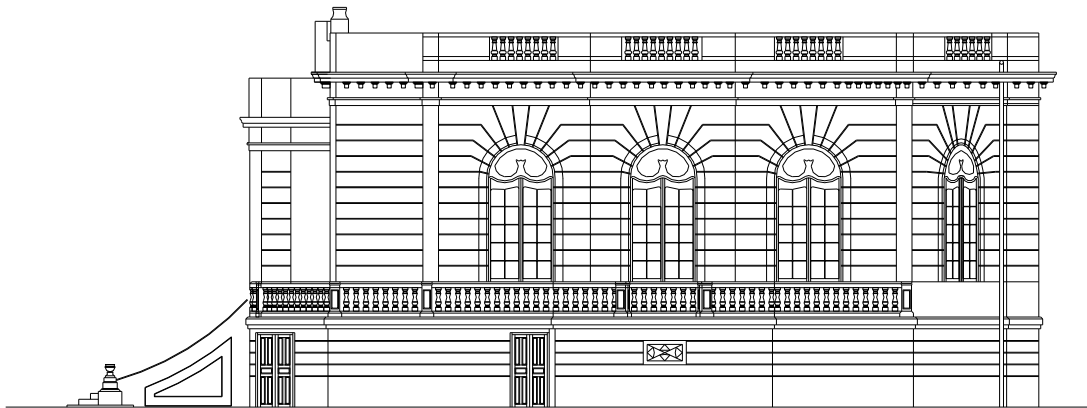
Fachada Sur, Proyecto de Restauración de la Casa del Lago.
